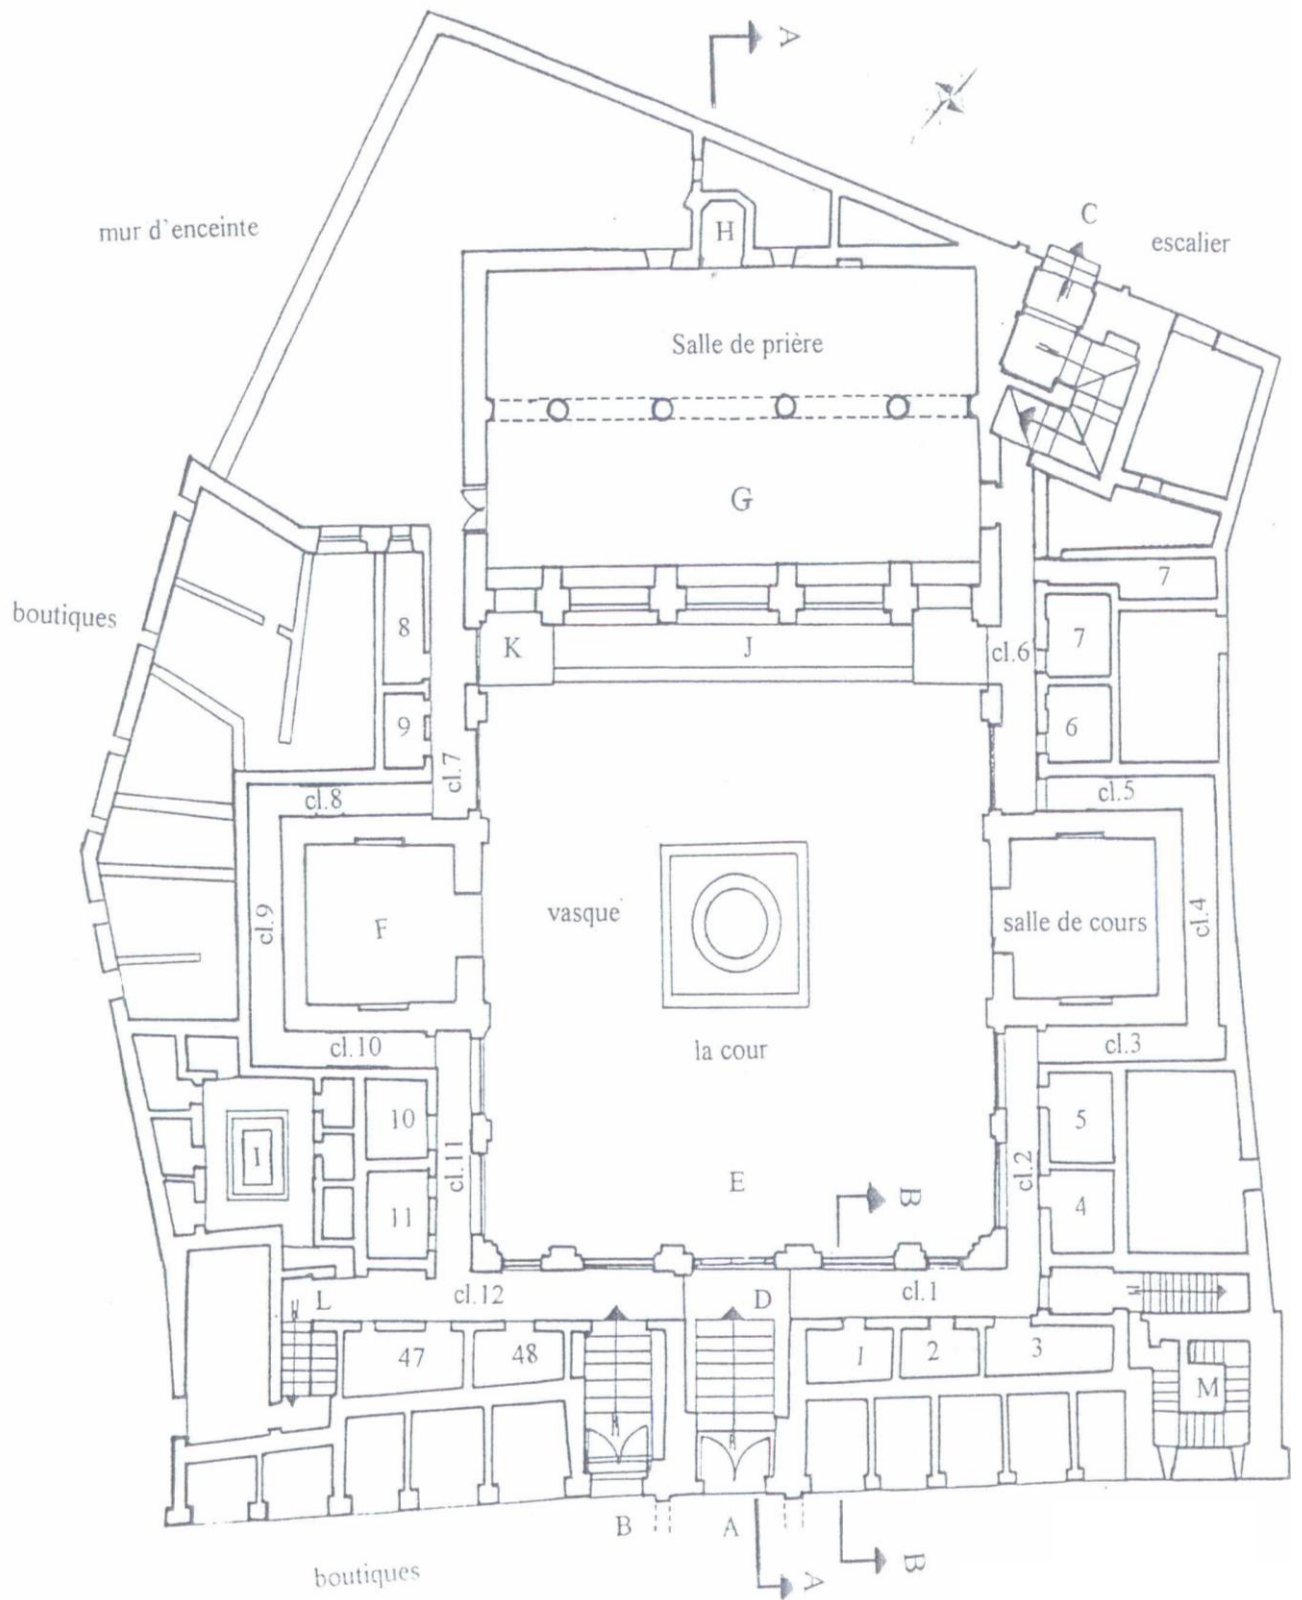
Fig B : Plan rez-de-chaussée de la medersa Al Bou Inaniyya
